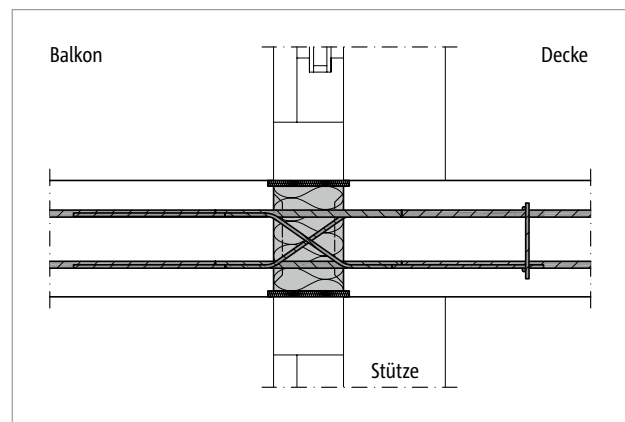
Schöck Isokorb® XT Typ DL: Einbauschnitt; Flachdecke
